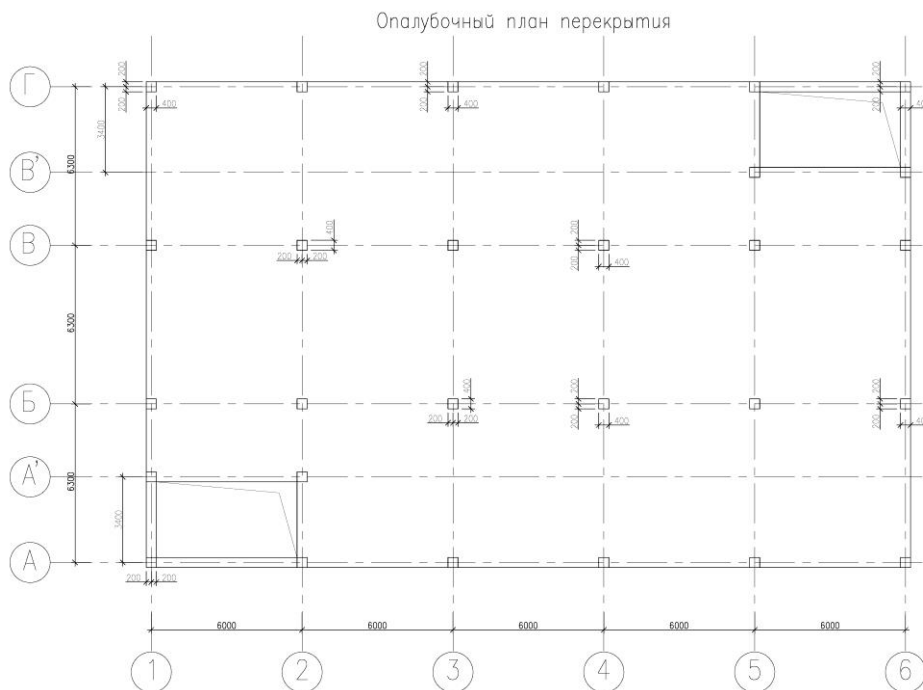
Пример компоновки безбалочного перекрытия с бескапитальным стыком колонны и плиты перекрытия— план
